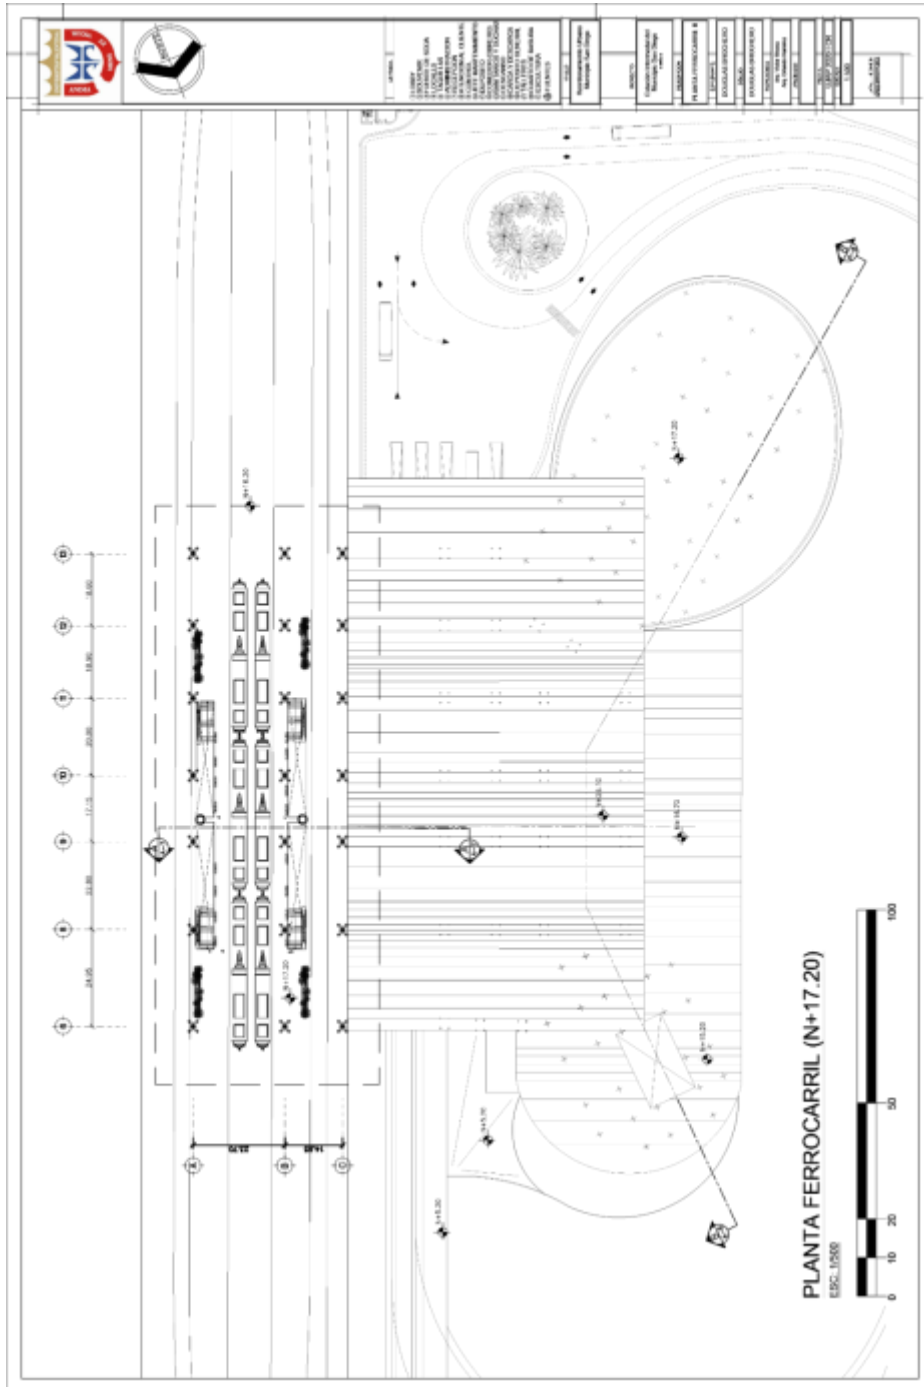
Planta Nivel Ferrocarril (N+17.20)
